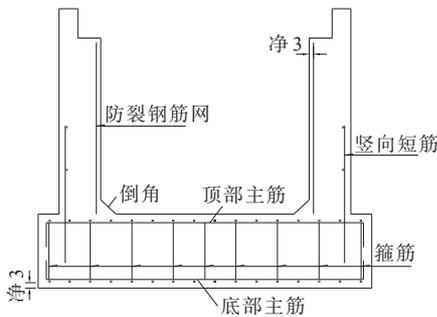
整体式基础及涵台钢筋布置示意图(单位:cm)
